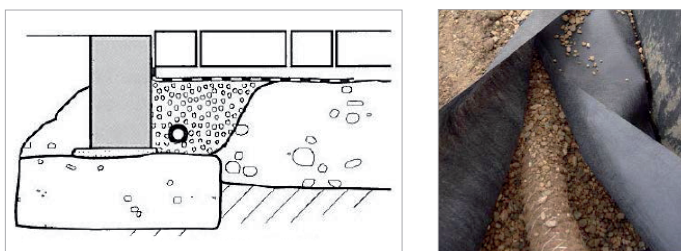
bande perméable sur le côté de la fondation en béton maigre avec tuyau de drainage et géotextile (membrane noire). Le géotextile évitera que les fines particules ne bouchent le tuyau de drainage (CRR, 2009)
